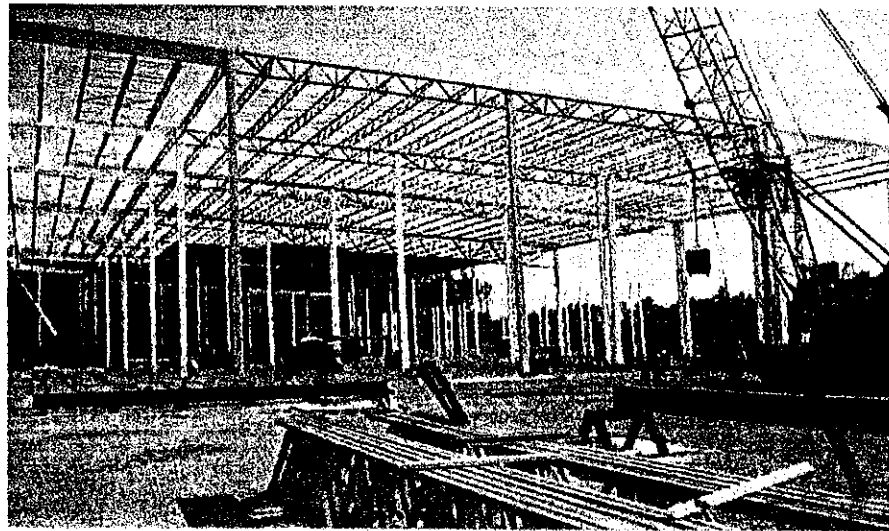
Montaje de estructura metálica en un edificio industrial utilizando grúa móvil sobre orugas. Véase que el material se ordena previamente a ser colocado en su sitio.
